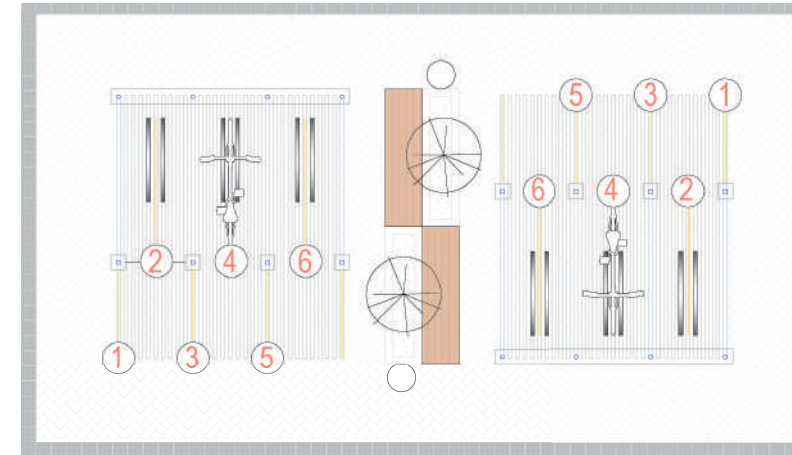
◀ Planimetría de diseño del ciclo-parqueadero.
